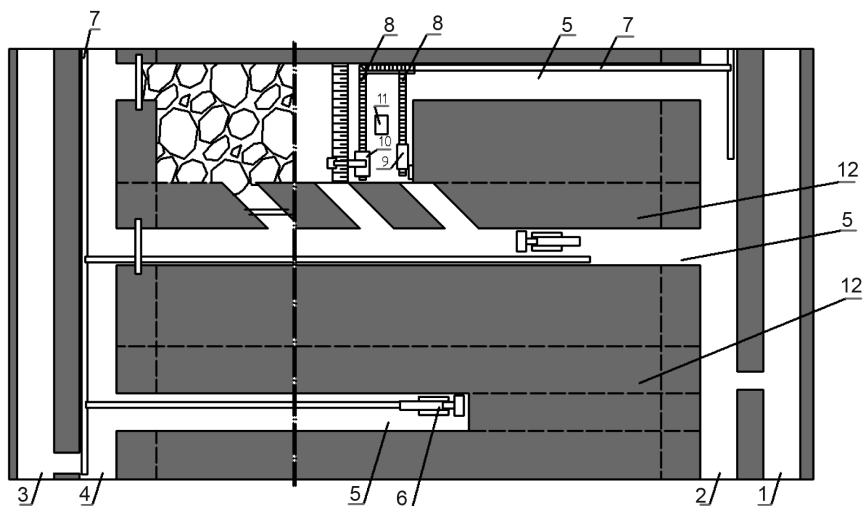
Вскрытие, подготовка и отработка мощного пологого угольного пласта столбами-камерами: 1 – главный воздухоподающий уклон; 2 – главный конвейерный уклон; 3 – фланговый воздухоподающий уклон; 4 – фланговый конвейерный уклон; 5 – подготовительные выработки; 6 – проходческий комбайн; 7 – ленточный конвейер; 8 – забойный конвейер; 9 – нишенарезная машина; 10 – экскаватор; 11 – анкероустановщик; 12 – саморазрушающийся целик
